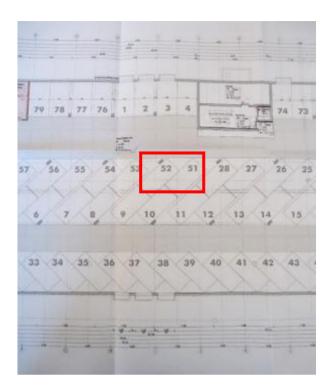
Grundriss Tiefgarage (3/4)
